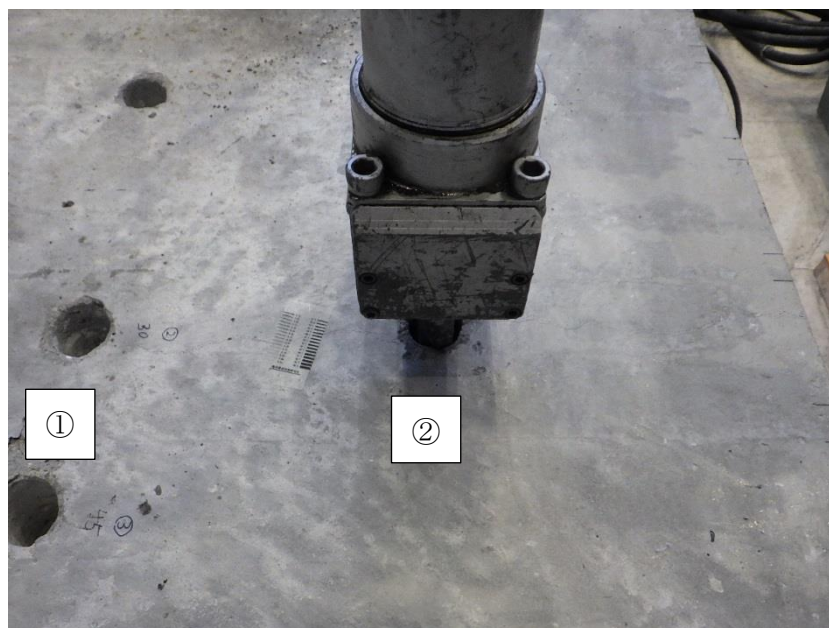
鉄筋コンクリート試験体ひび割れ発生状況 (②拡張後 1/2)
